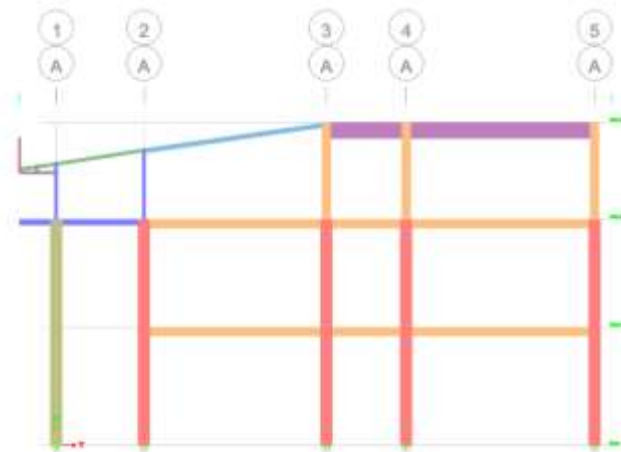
Vista en elevación de la facultad de ingeniería en Etabs.
